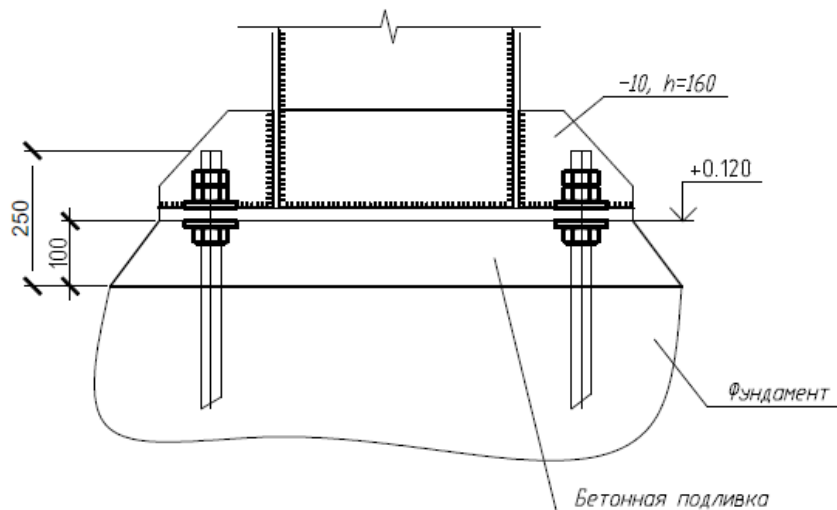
Узел монтажа несущих колонн здания с фундаментом
